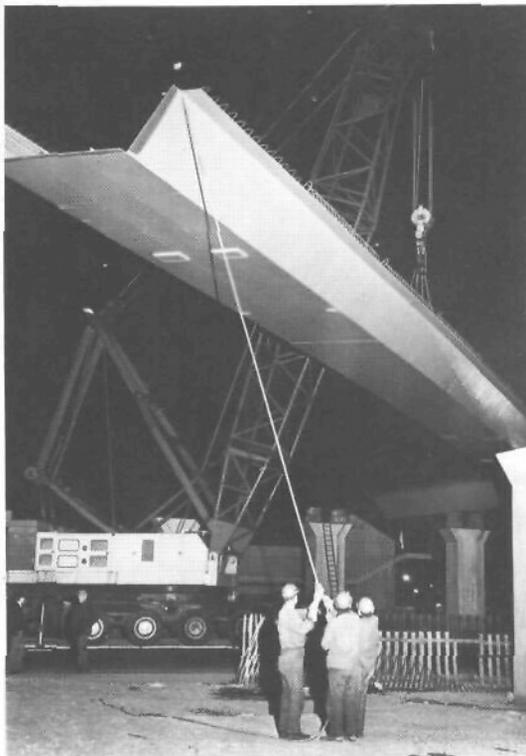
Caisson mis en place par une grue au sol. La grue est calée sur vérins, elle ne peut se déplacer. Les tronçons doivent être approvisionnés dans le rayon d'action de la flèche. En site urbain cet approvisionnement peut présenter des difficultés.
